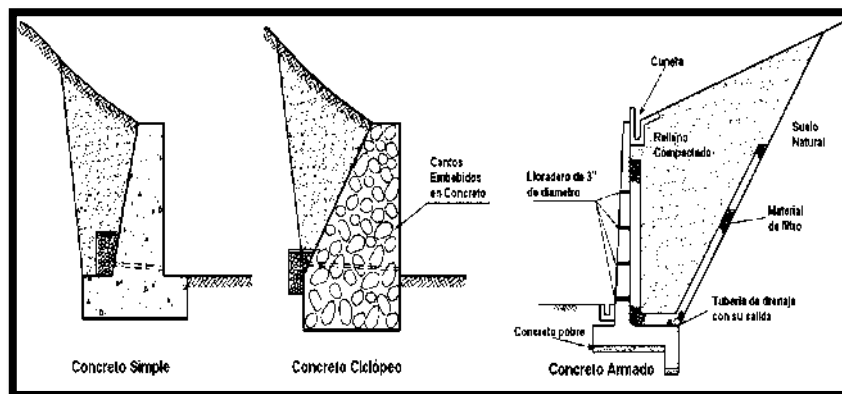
Tipos de muros rígidos (Modificado de Suárez, 1998).
